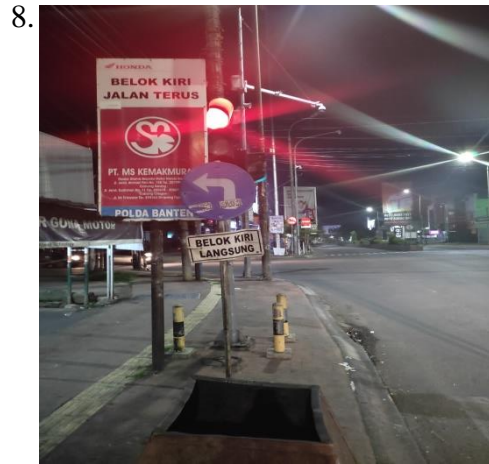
Potongan Site Plan Titik Lokasi Rambu
